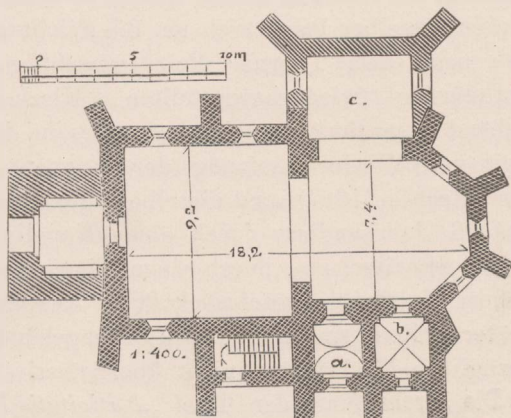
Schönwalde. Grundriss der Kirche.
